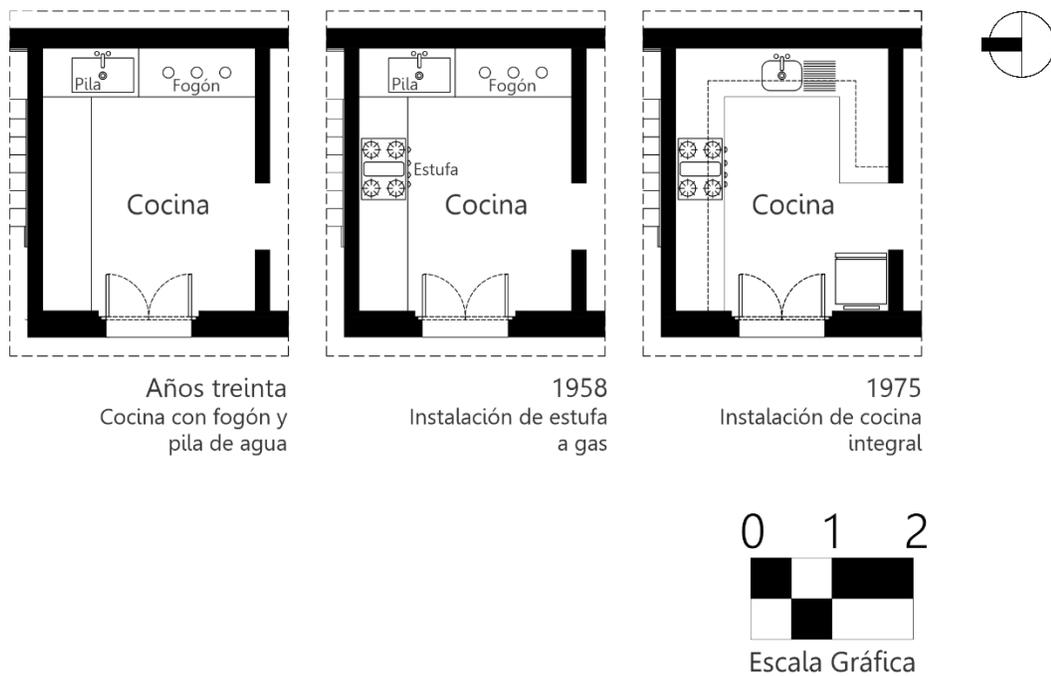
Sección de plantas arquitectónicas donde se muestra la modificación de la cocina en los años de 1958 y 1975. Elaborado por KNV.
